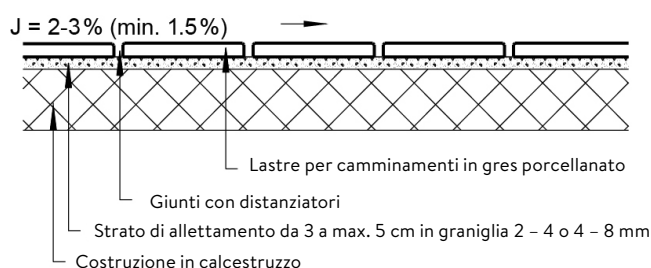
Struttura del rivestimento in lastre sopra una costruzione in calcestruzzo rigida con strato di allettamento
